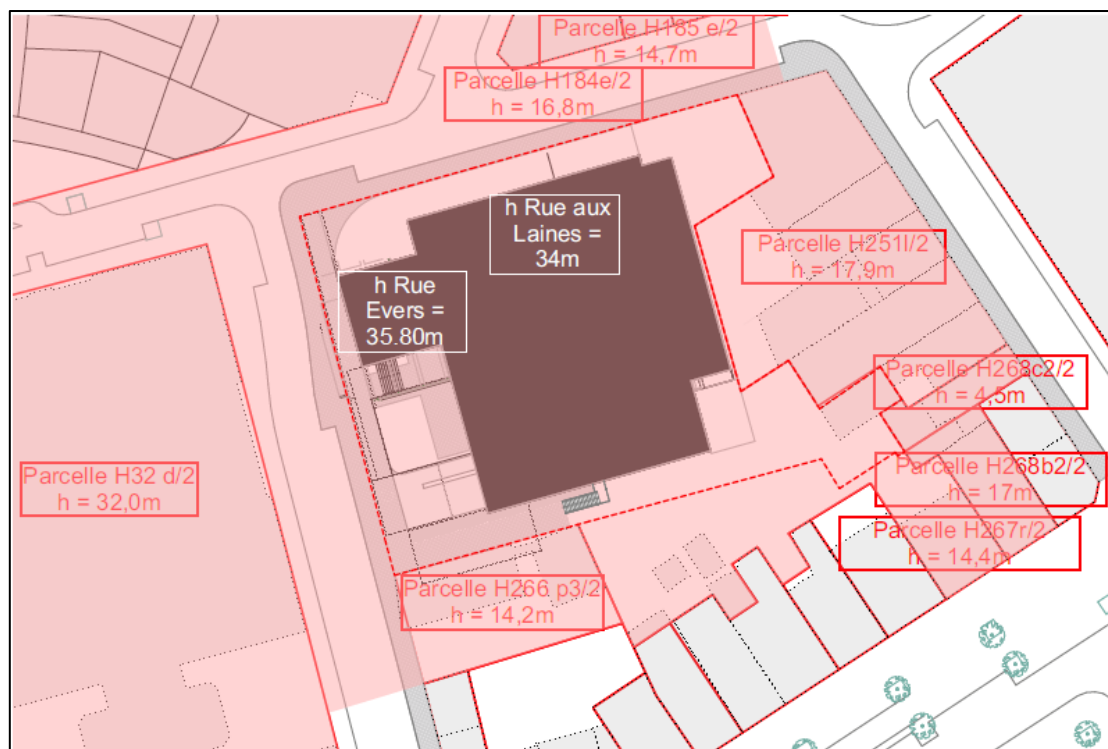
Hauteur des bâtiments voisins (Source : POLO et Baumans-Deffet)
